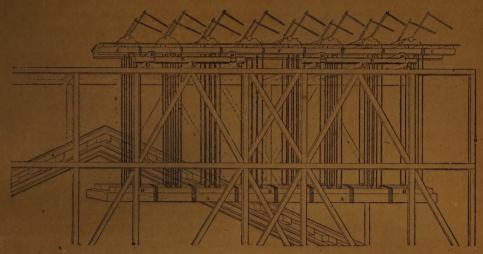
Machine ayant servi à élever et poser les pierres du fronton du Louvre.
